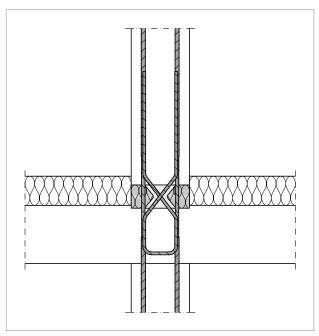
Schöck Sconnex® type W-NT-VH-L : coupe D-D ; liaison par force de traction des murs à travers la dalle
